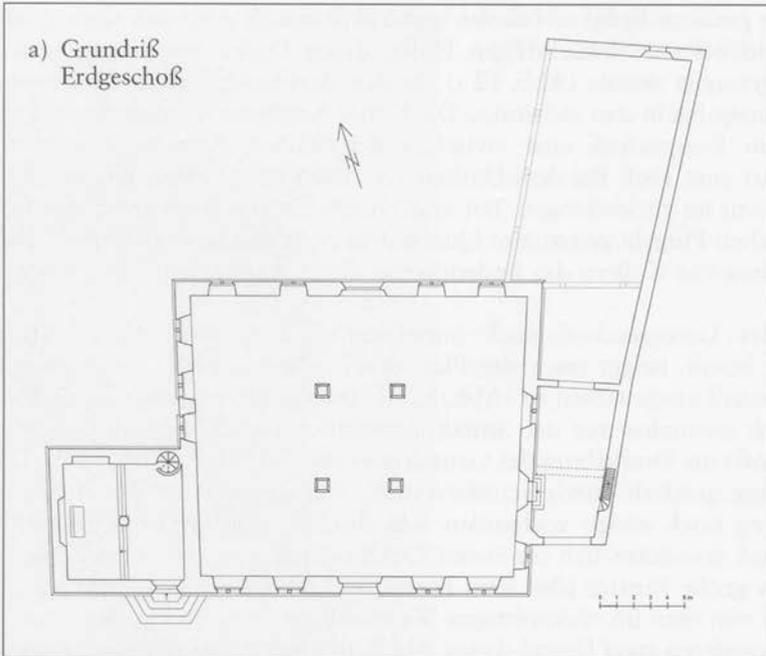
Rekonstruktion der bauzeitlichen Grundrisse (nach den Bestandsplänen von 1960 und eigenen Aufnahmen)
